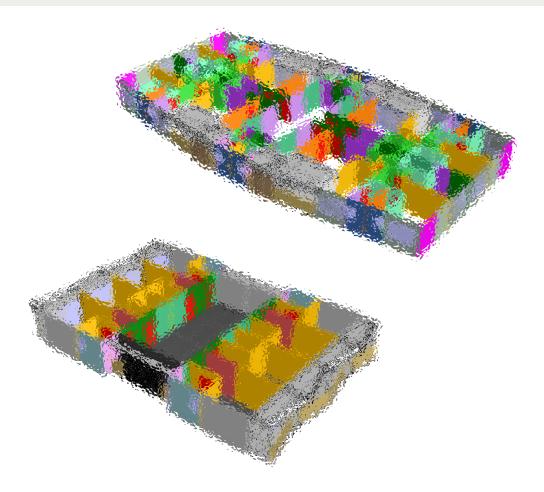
Modelagem do empreendimento | Exemplo para o Pavimento Tipo de cada torre.
